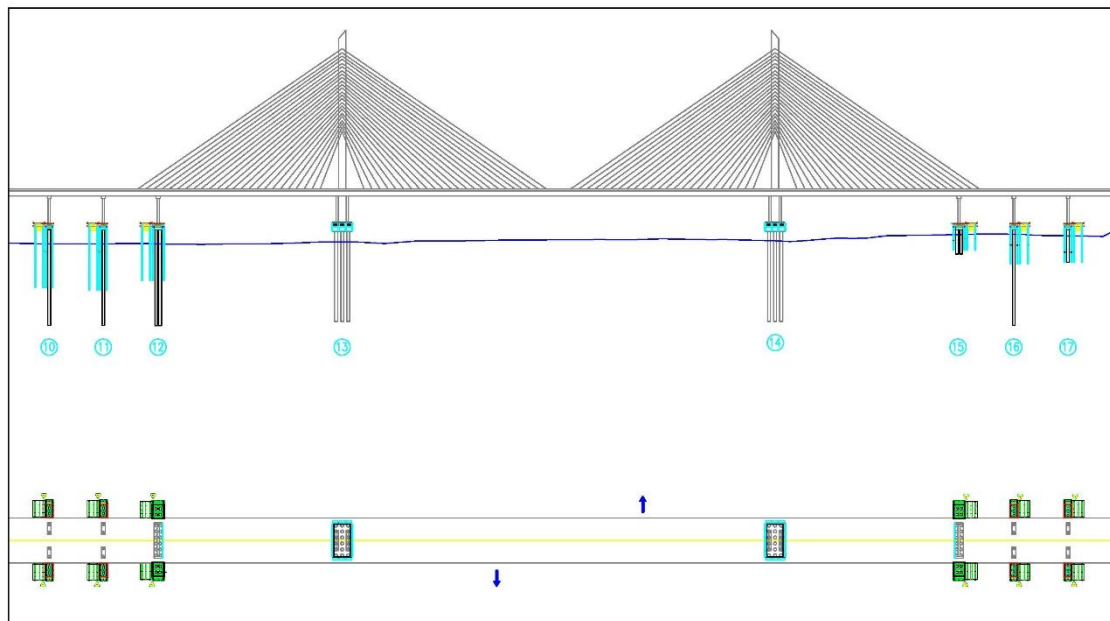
淇澳大桥防撞设施施工平台总体方案布置图
